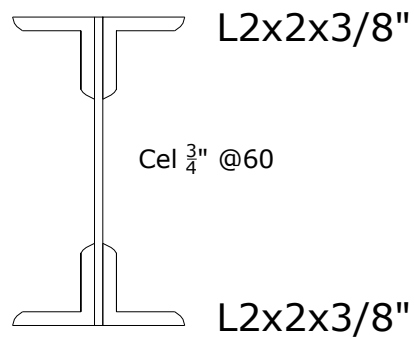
Diseño de viga primaria estructura de techo LRFD (propuesta como viga macomber)
